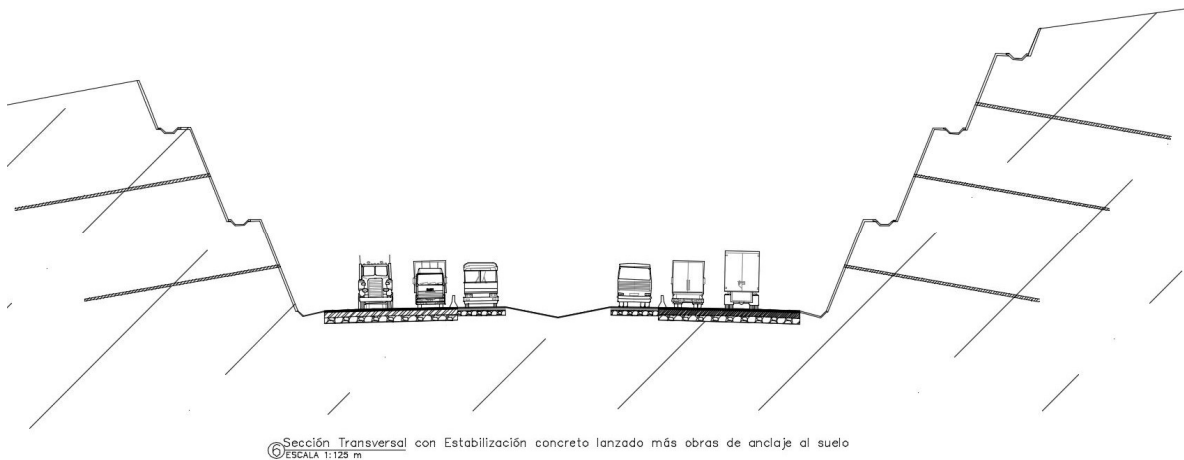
Estabilización opcional de los taludes con concreto lanzado más obra de anclaje al suelo, con bermas con un ancho de 2.5 metros de ancho por cada 7 metros de altura.
